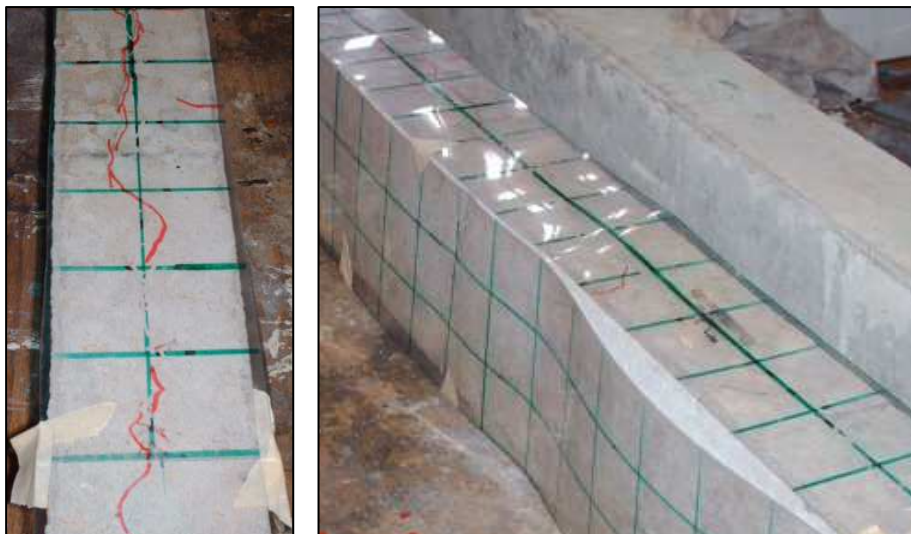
Cuadrícula utilizada para la ubicación de fisuras en las vigas
